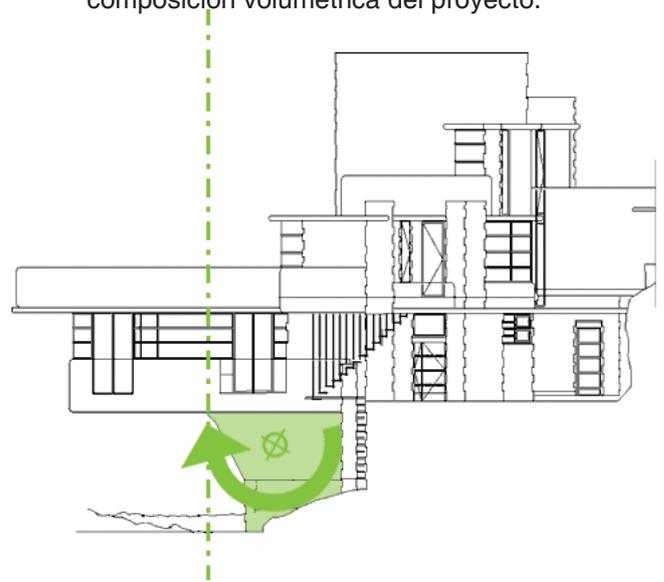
Momento estabilizante de vigas de apoyo. Infografía de Autor.
